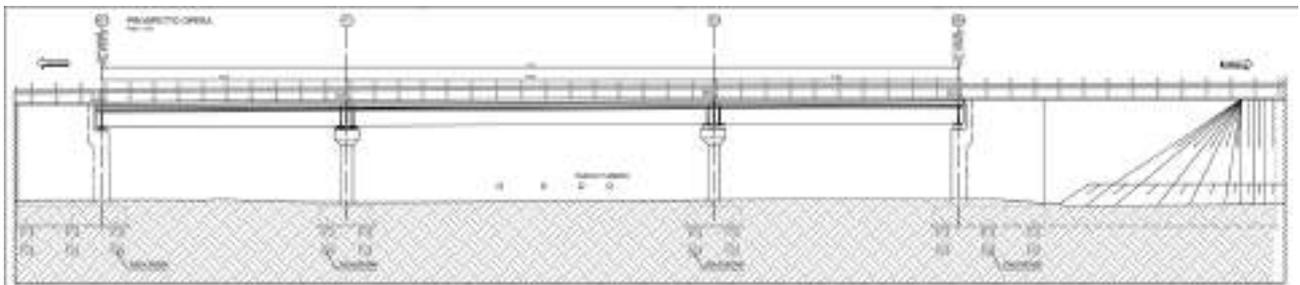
Prospetto del ponte scavalco fascio tubiero alla prog. 6+749.00.
